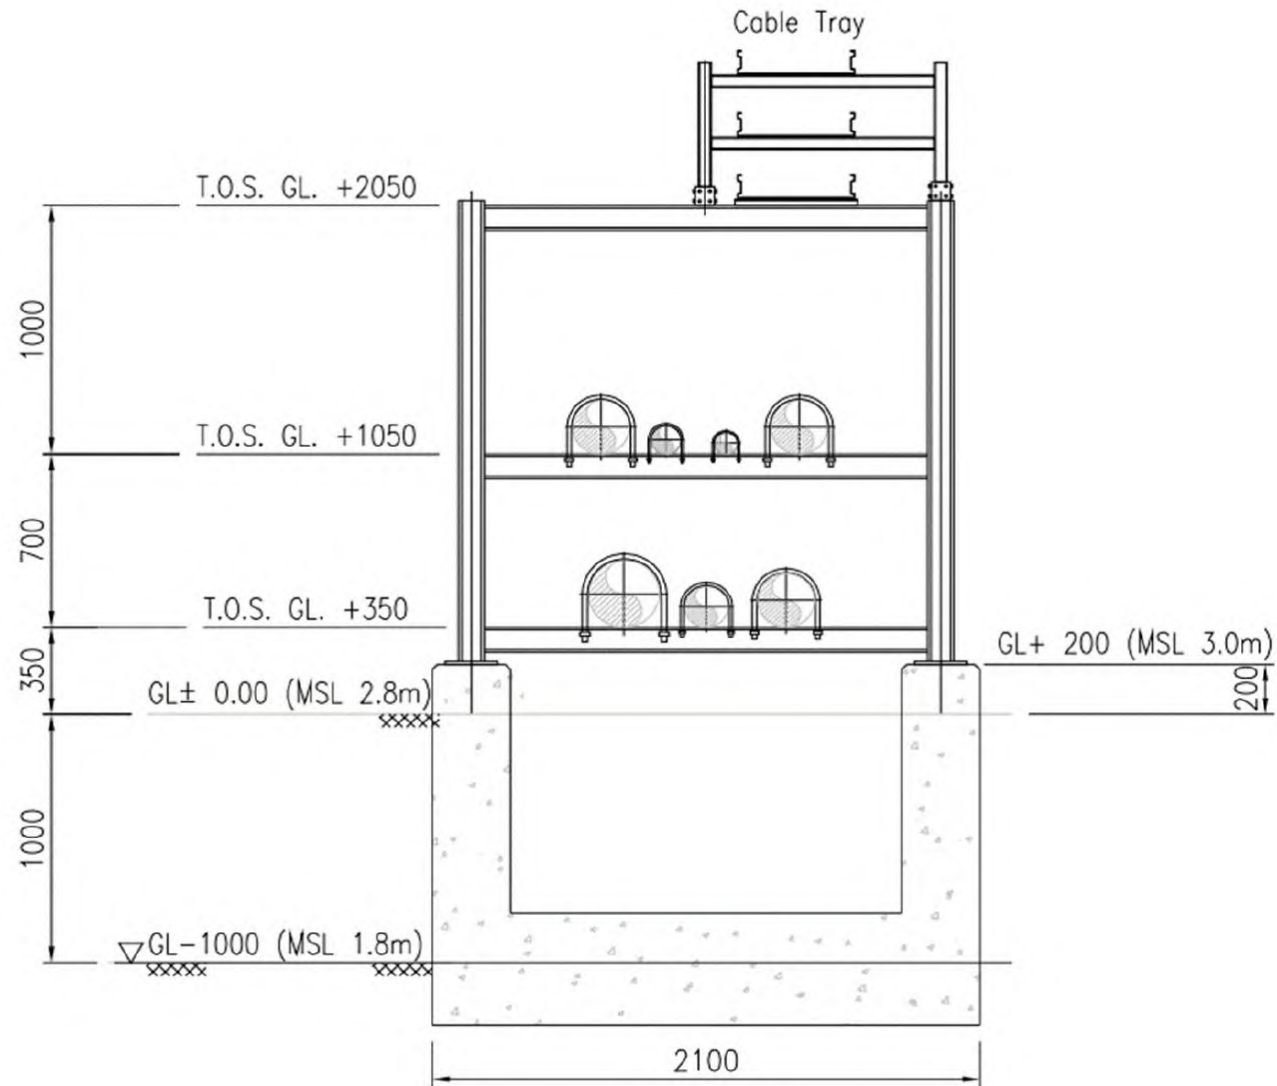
แนวท่อก๊าซธรรมชาติที่วางท่อน Pipe Rack ภายในโครงการ
